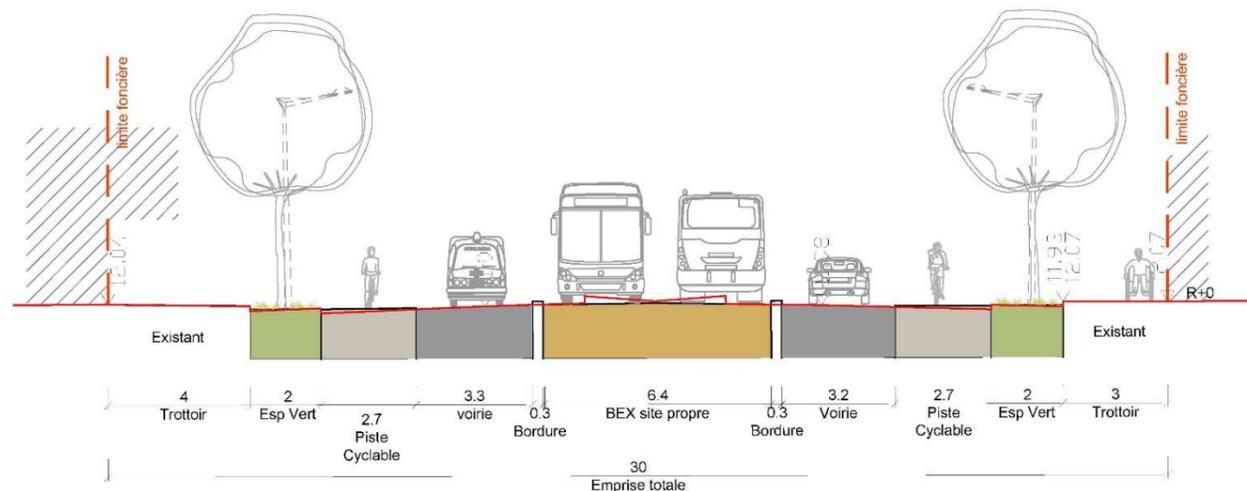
Coupe type sur le boulevard Pompidou en section courante
